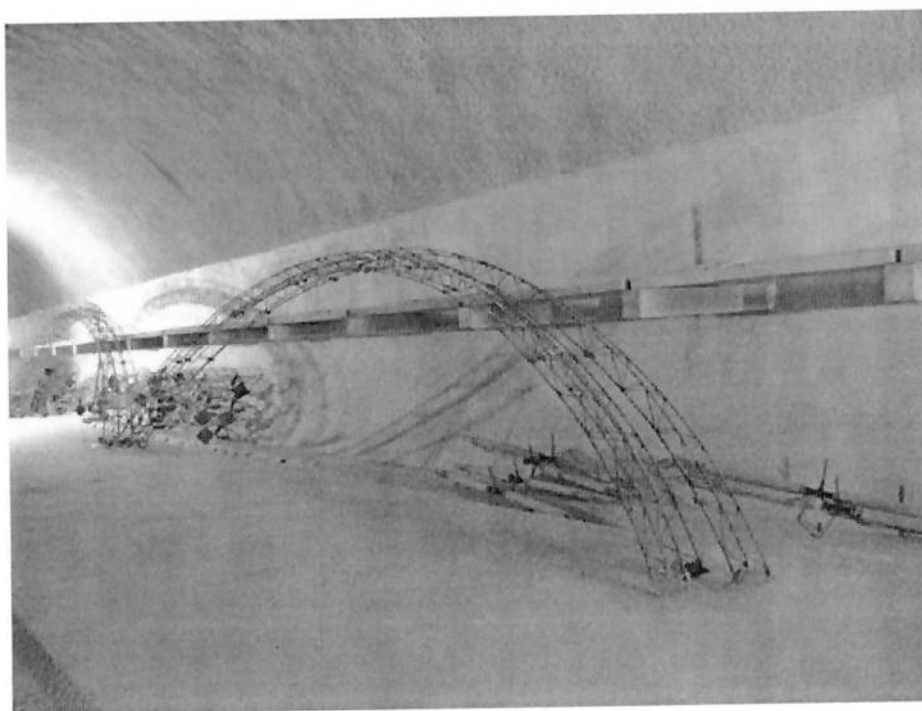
Foto da cambota utilizada para estruturação do túnel
